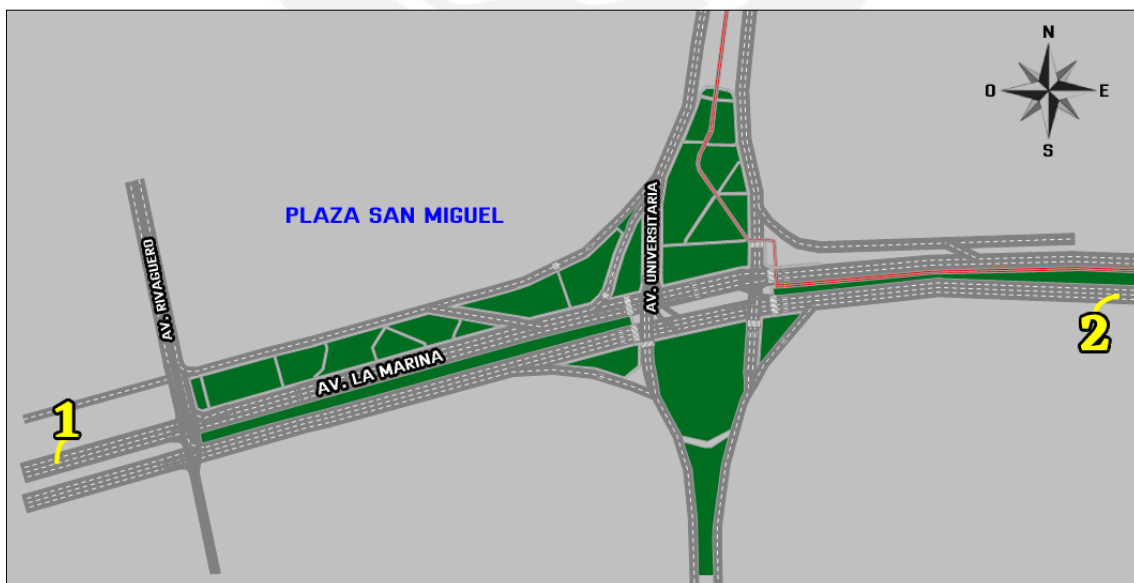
Vista en planta con el inicio (1 y 2) de las dos rutas.
